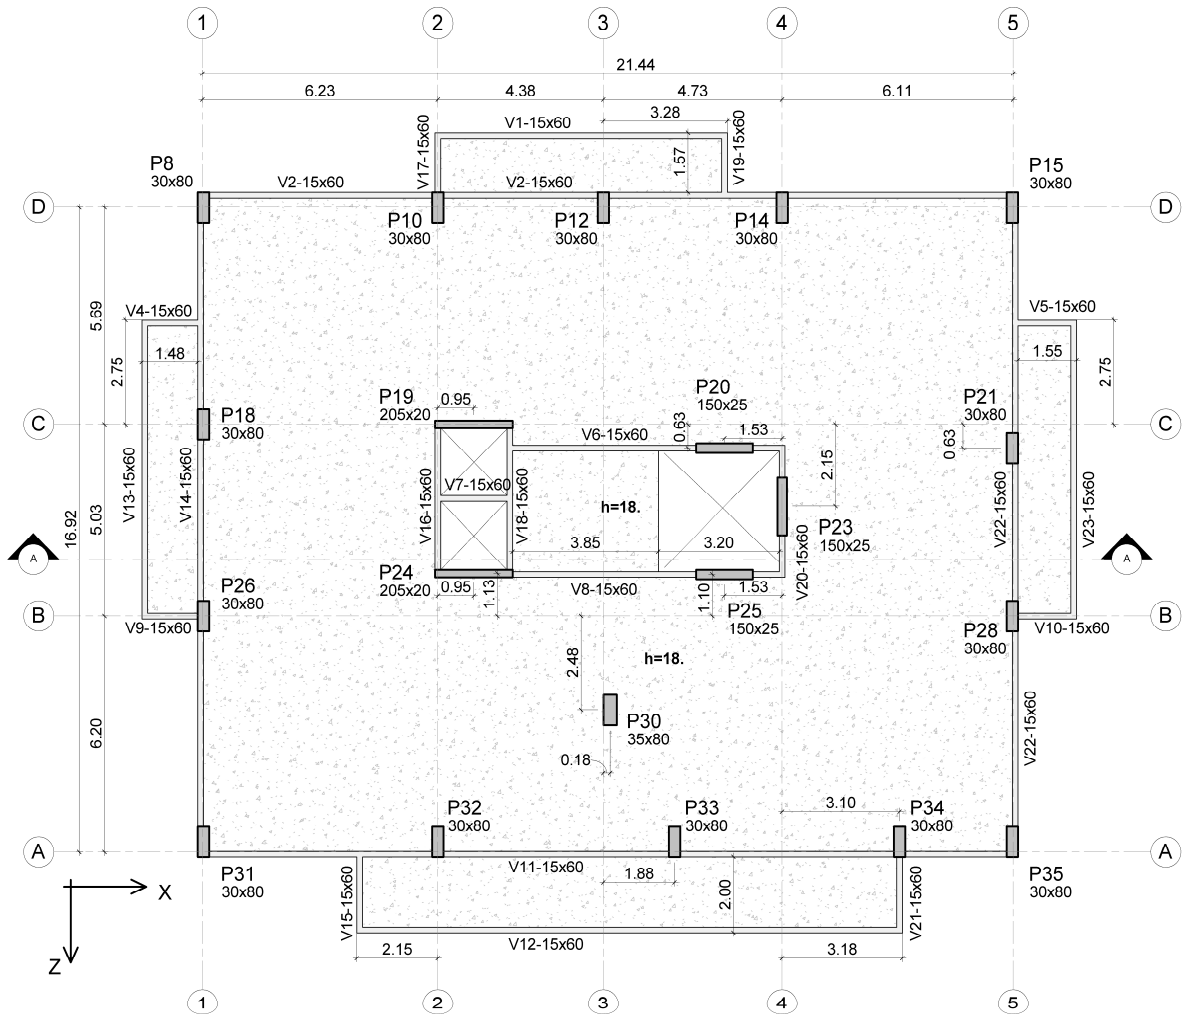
Planta estrutural - Modelos A e B - Unidades em metro.
